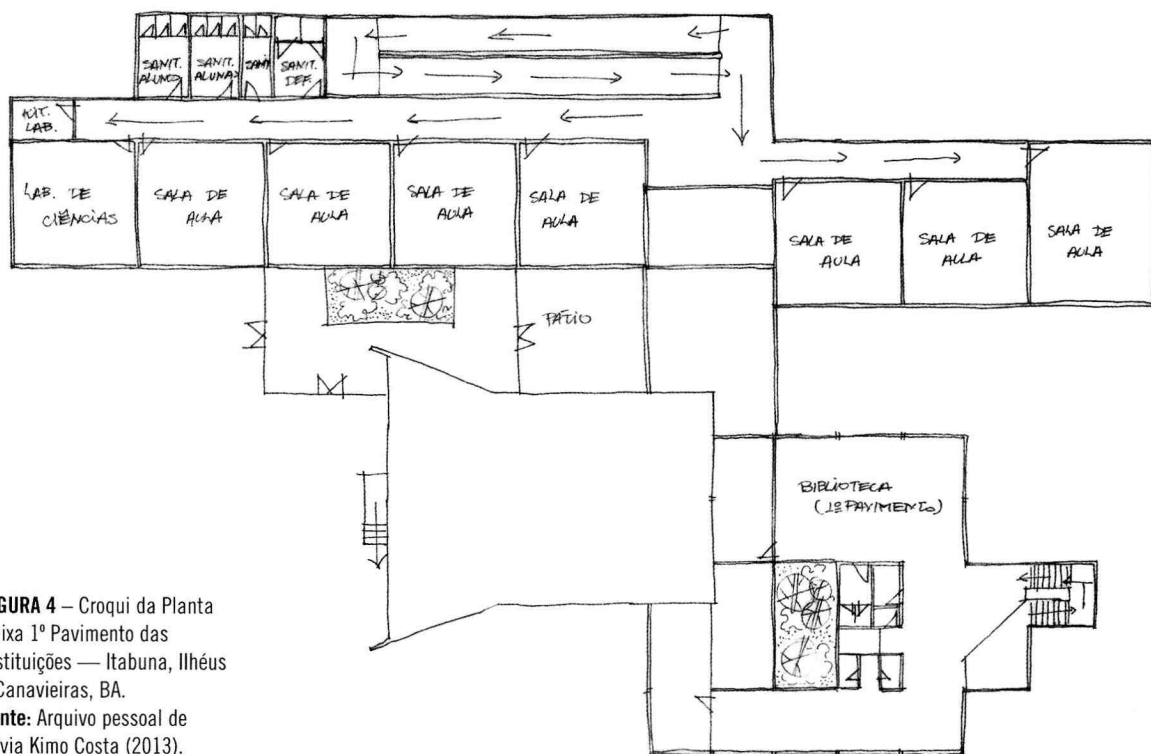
Croqui da Planta Baixa 1º Pavimento das Instituições — Itabuna, Ilhéus e Canavieiras, BA.
